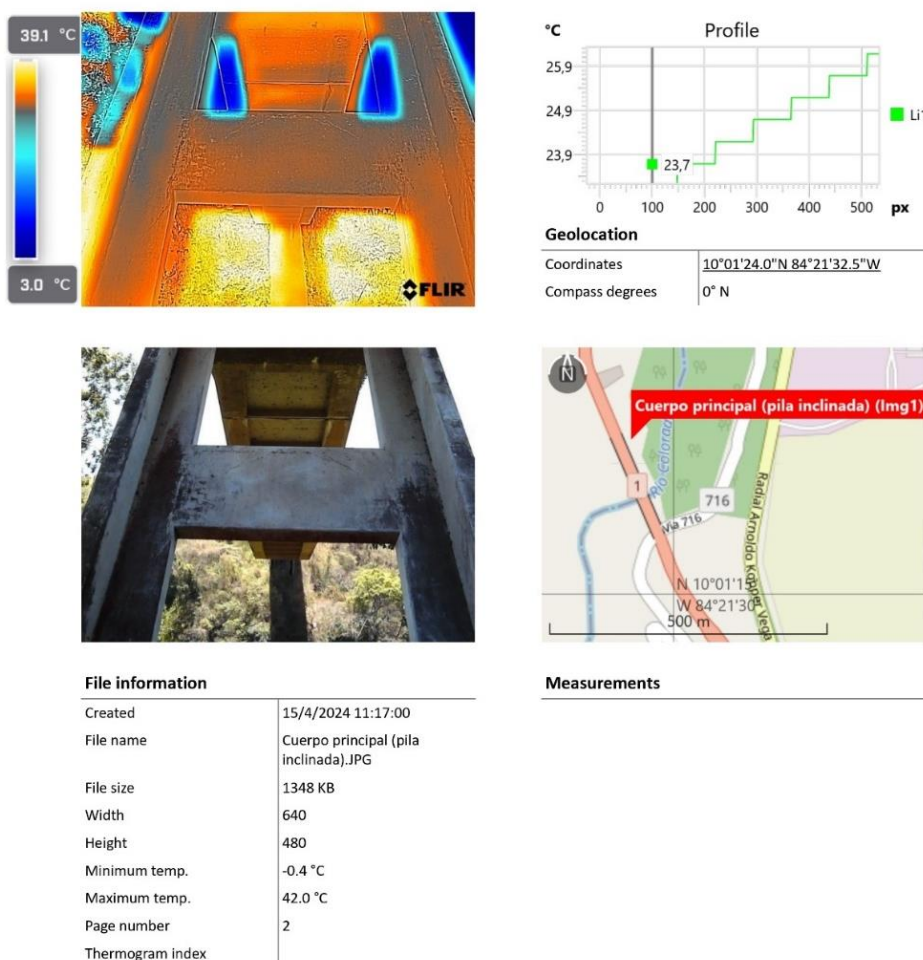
32 Reporte térmico de grietas en cuerpo principal (pila) de la sección No. 8
